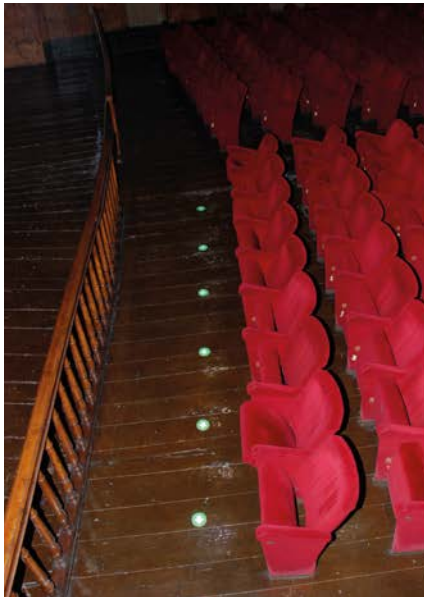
A sinistra, la vista della prima fila della platea con la segnaletica a pavimento;
